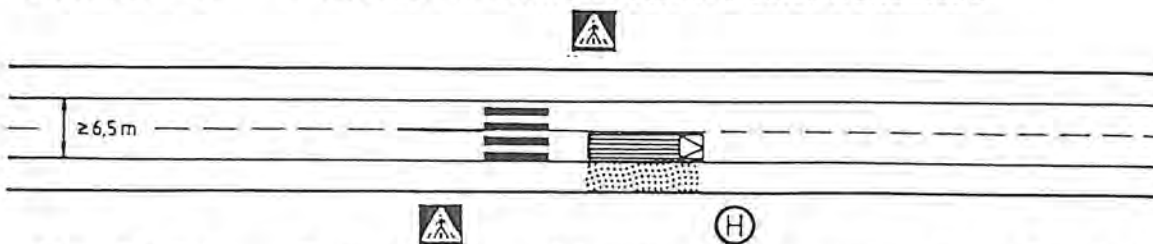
Durchgehende Längsmarkierung an einer Fahrbahnhaltestelle
